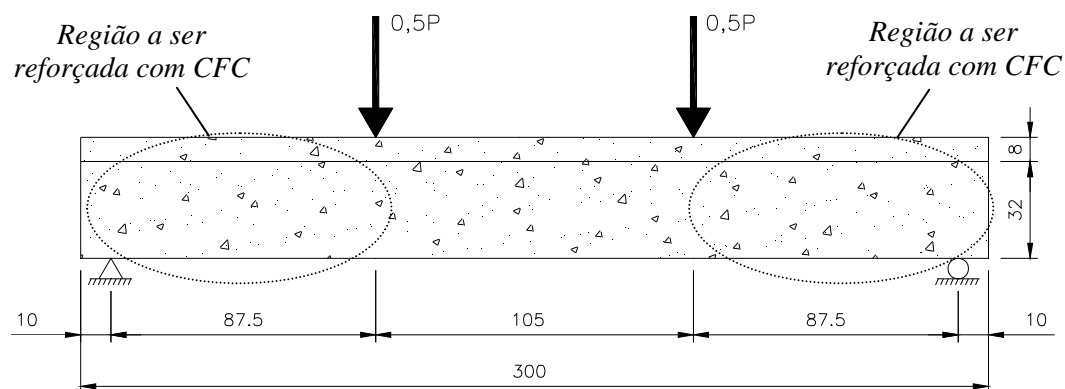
Esquema de aplicação de forças às vigas (cotas em cm).
